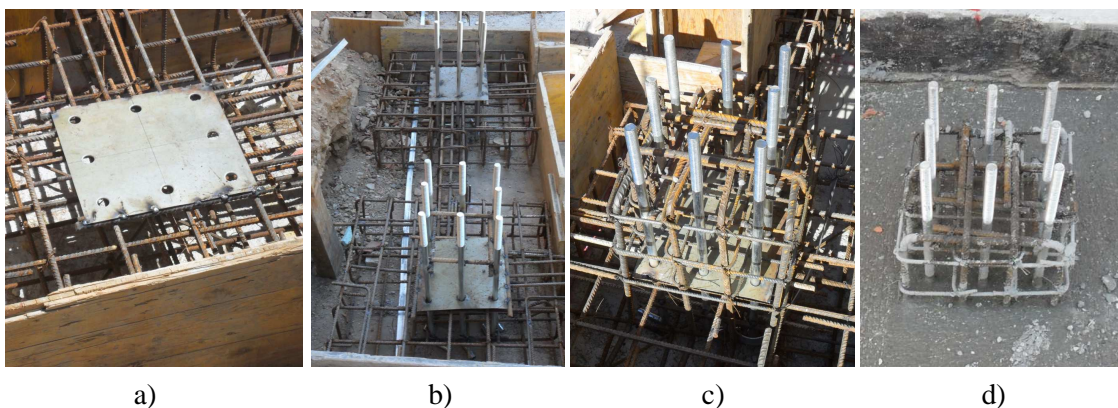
Execução dos chumbadouros para as escadas metálicas
